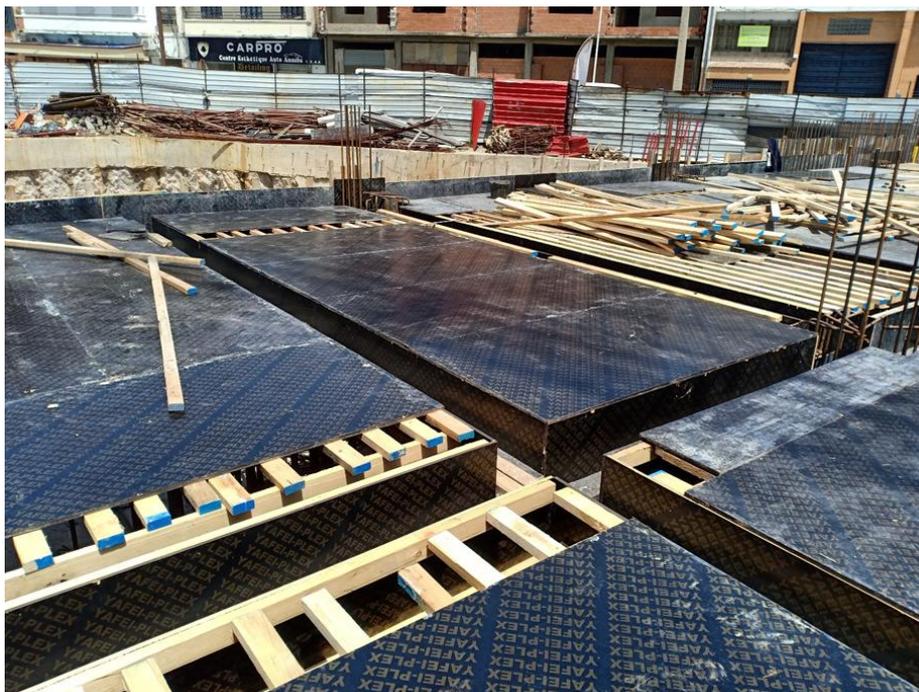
Disposition des panneaux de coffrage pour plancher niveau +0.15 (platelage)
